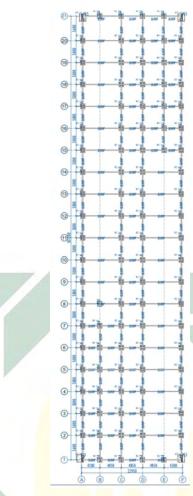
12 Denah Rangka Atap Pasar Pabean Baru
